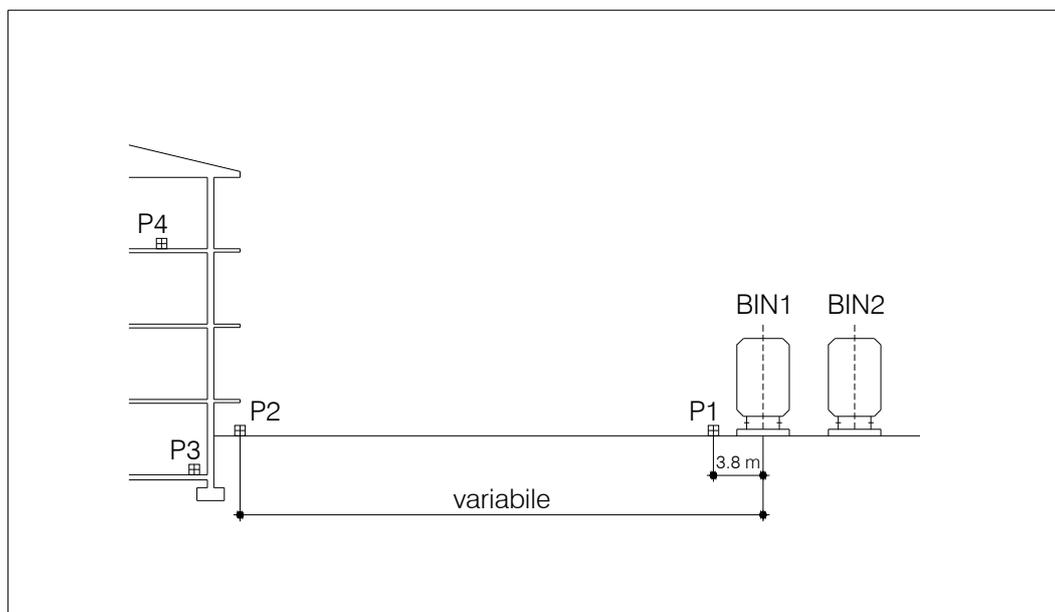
Sezione trasversale tipo con indicazione delle postazioni di monitoraggio
